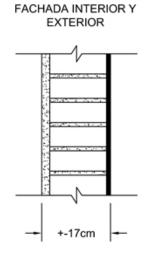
Fachada sin muro de carga a partir de 1939-1940
